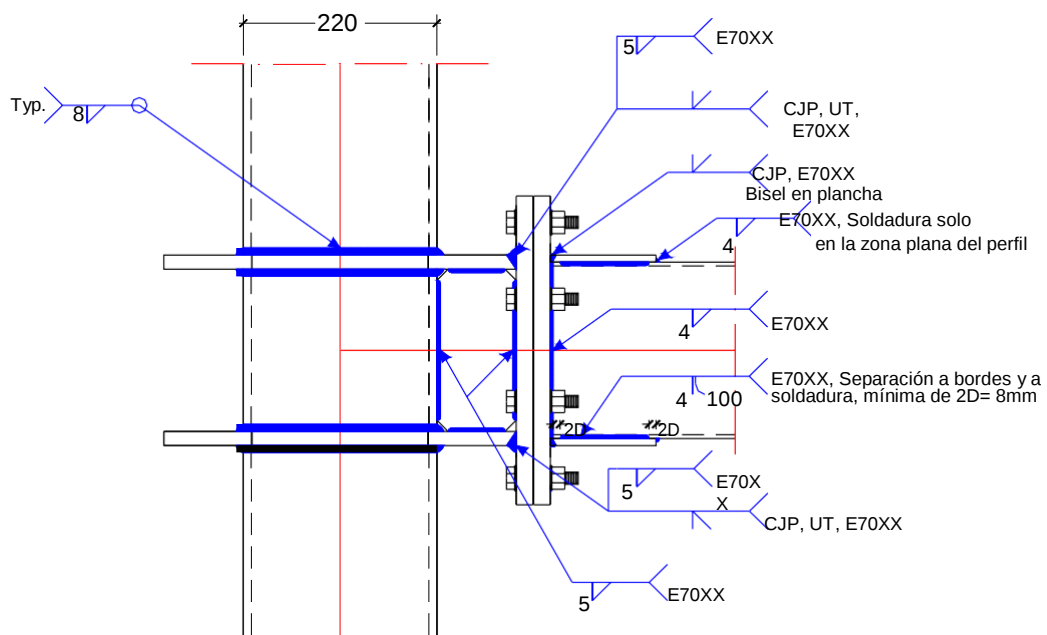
Detalles de las soldaduras de la conexión a momento emperrada
